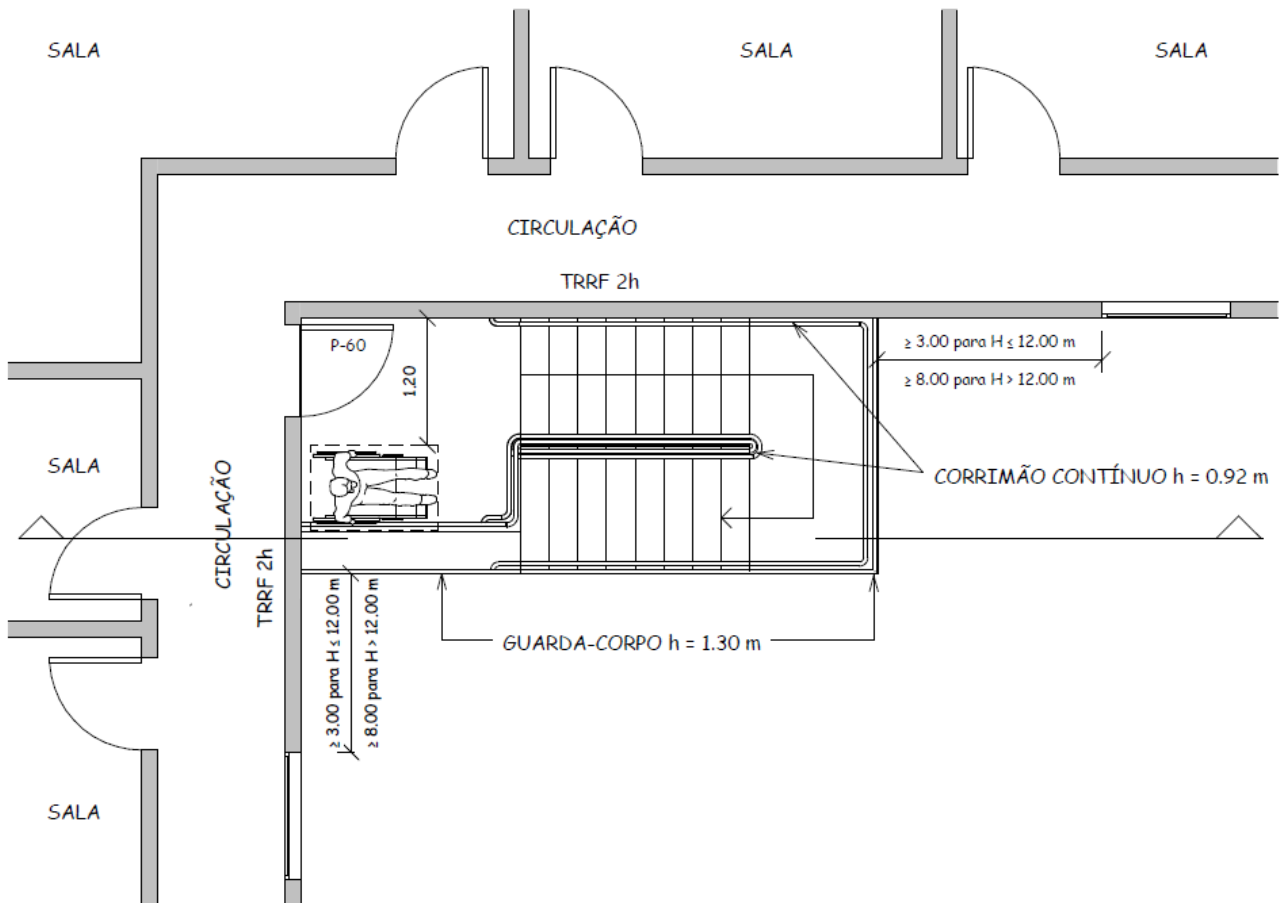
C - Escada aberta externa - último pavimento (planta baixa).
